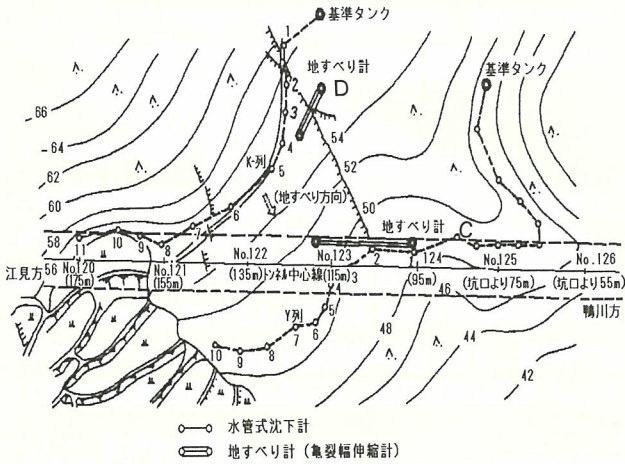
平面図と亀裂および計測器の位置¹⁰⁾
